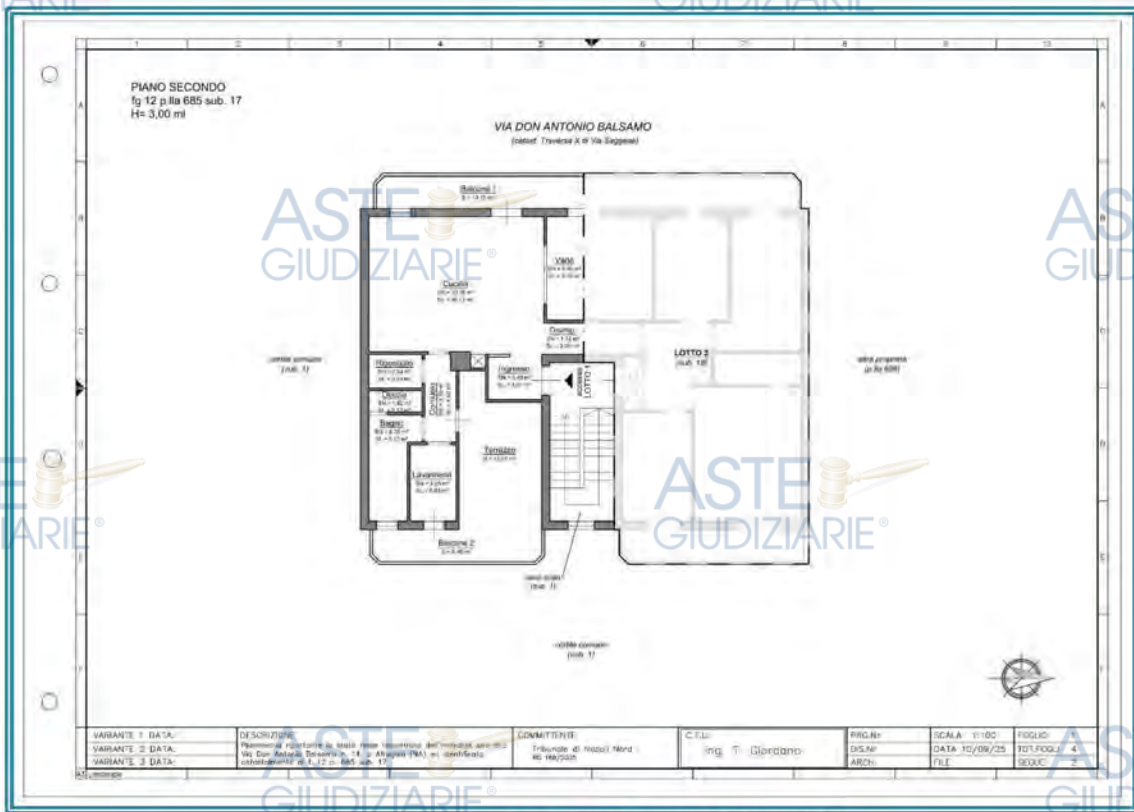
Stato attuale - Piano Secondo (LOTTO 1)
